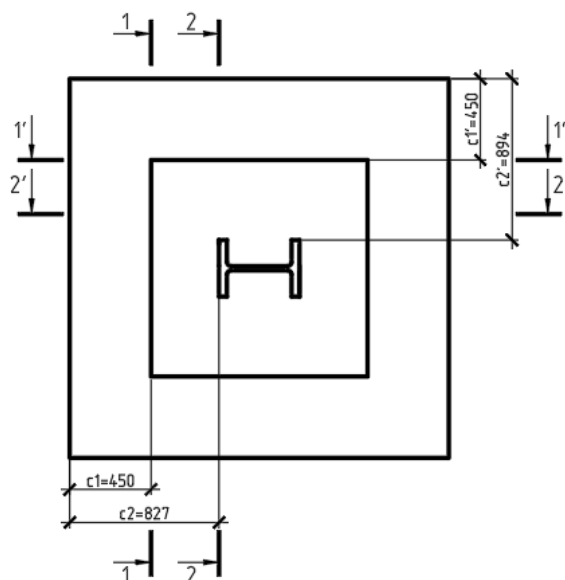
Схема к расчету арматуры плитной части фундамента
